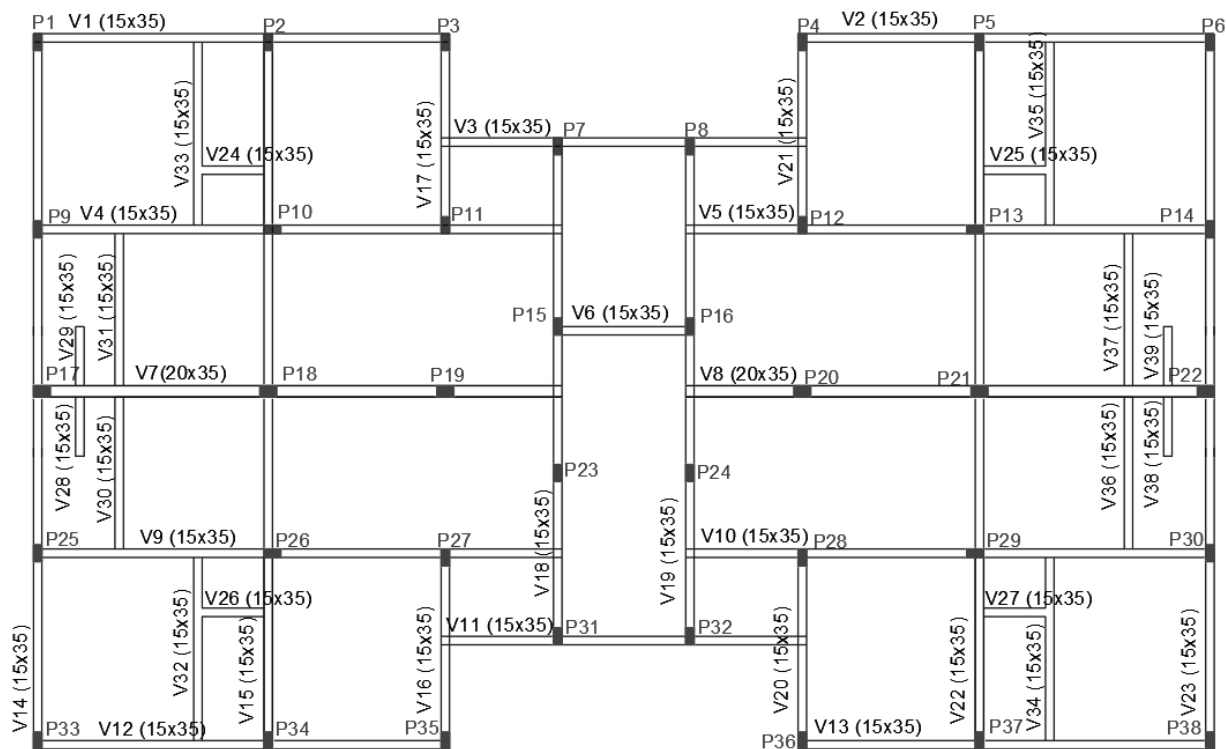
Vigas baldrame dos edifícios de oito pavimentos (cm)
